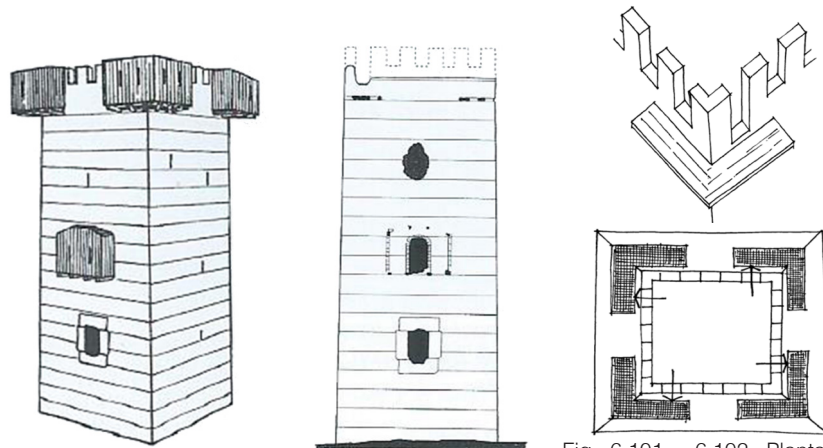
6.100. Reconstrucción hipotética del aspecto original. Alzado de la torre en su estado actual y con la reconstrucción del almenado. (Según Cantos Carnicer)
